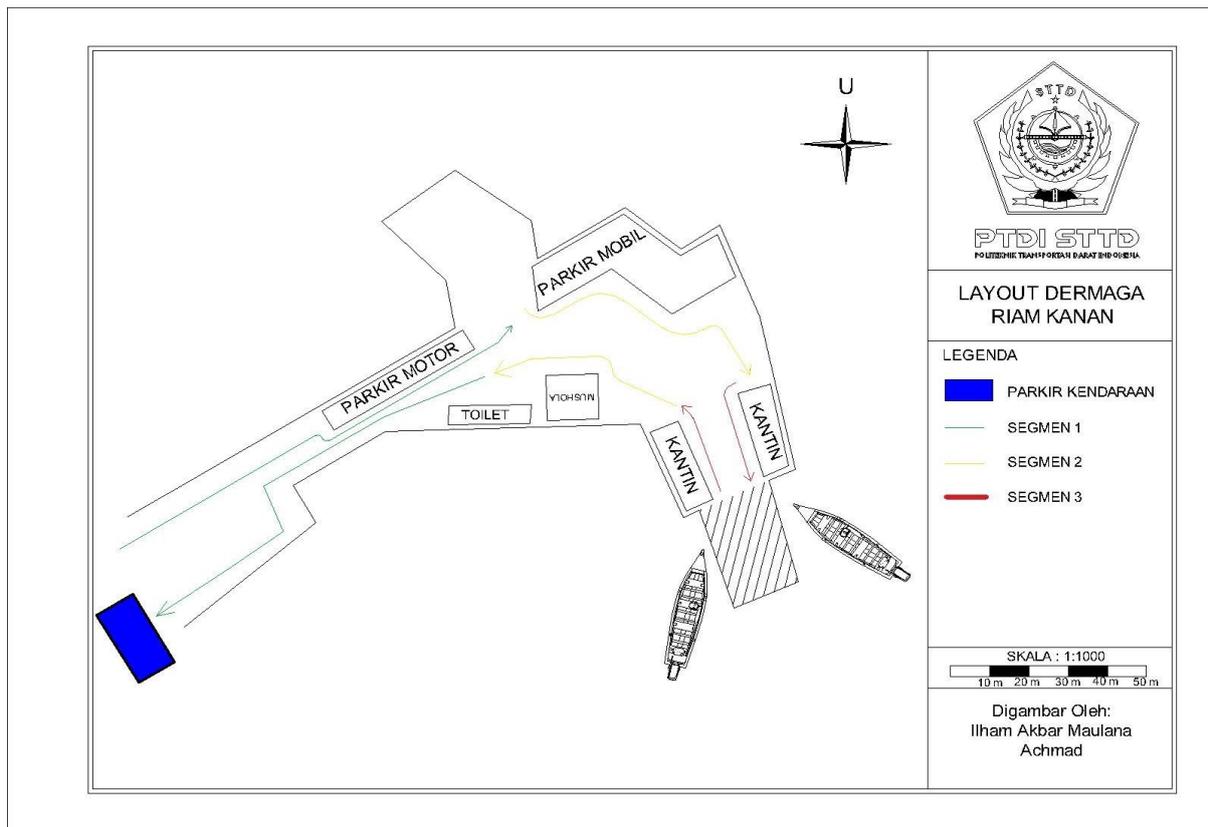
Layout Alur Penumpang di Dermaga Riam Kanan Eksisting
